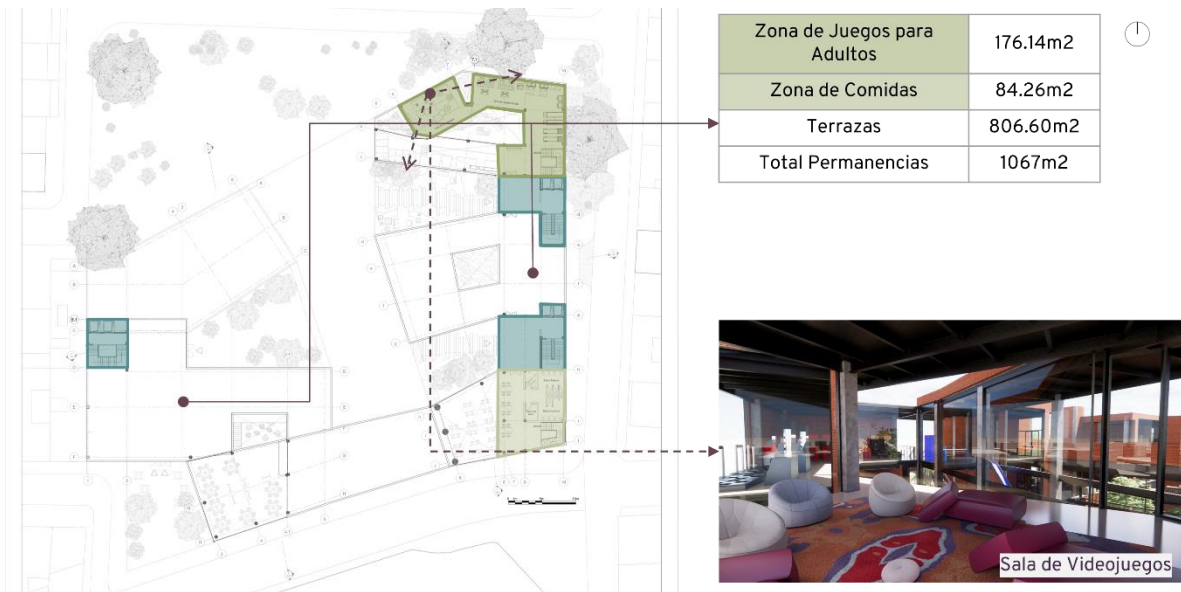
Planta de cuarto nivel con actividad. Fuente: Elaboración propia
